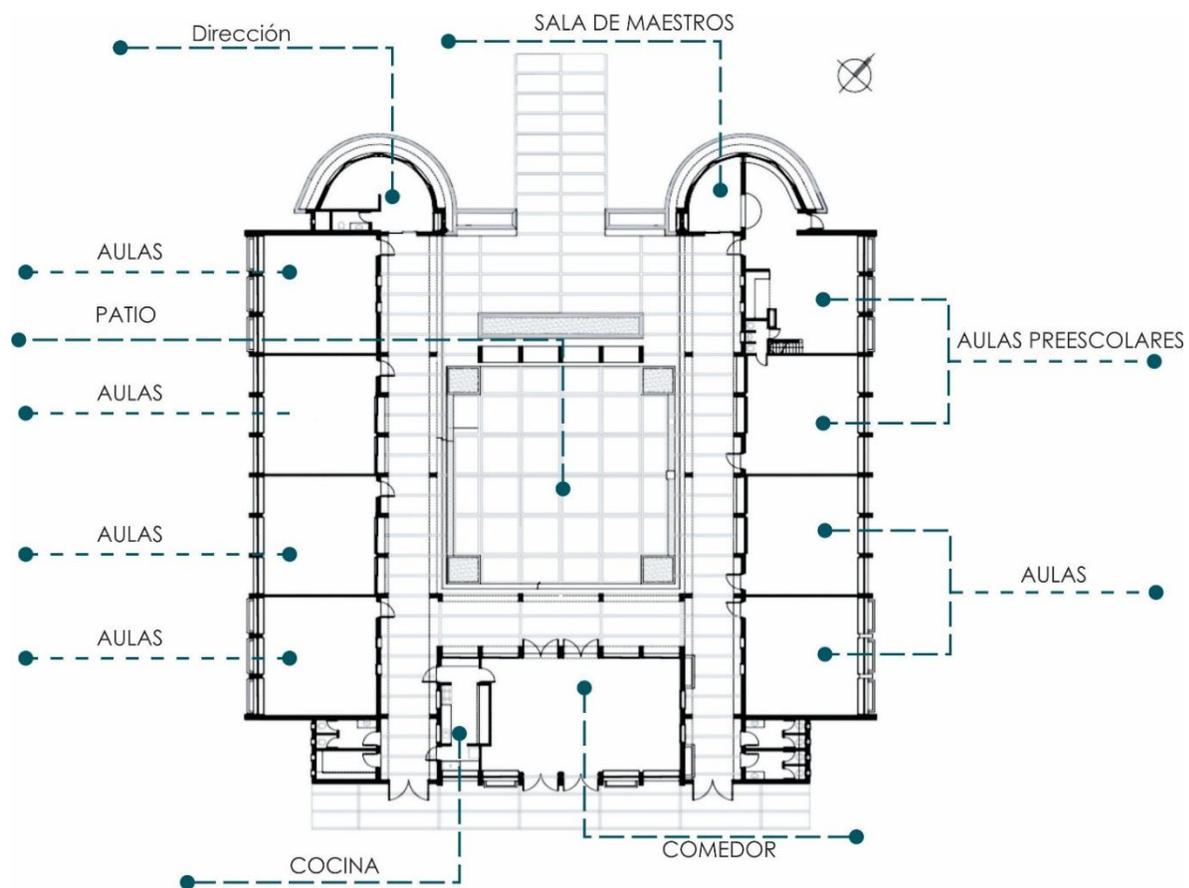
Imagen del plano arquitectónico de la ETC N° 277. (MECAEP, s.f.)
